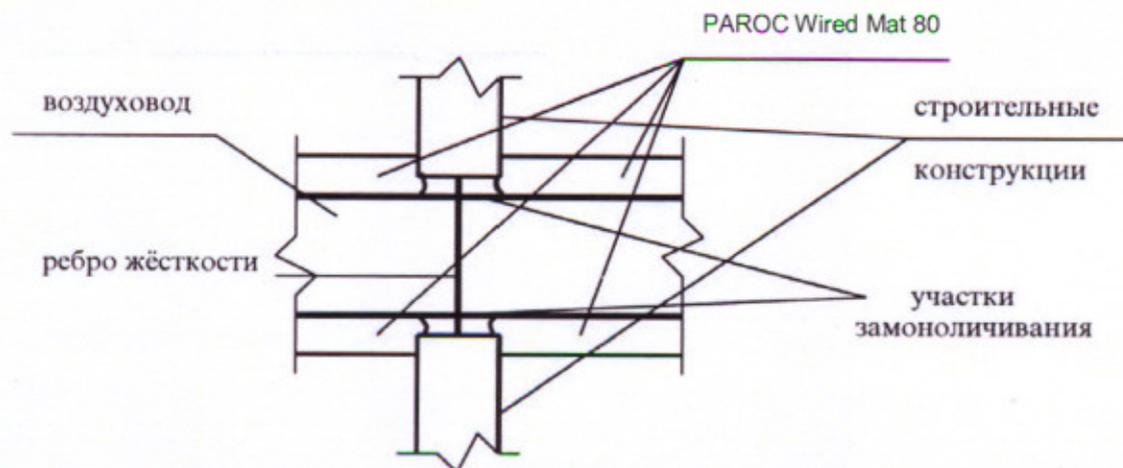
Принципиальная схема пересечения воздуховодом строительной конструкции
